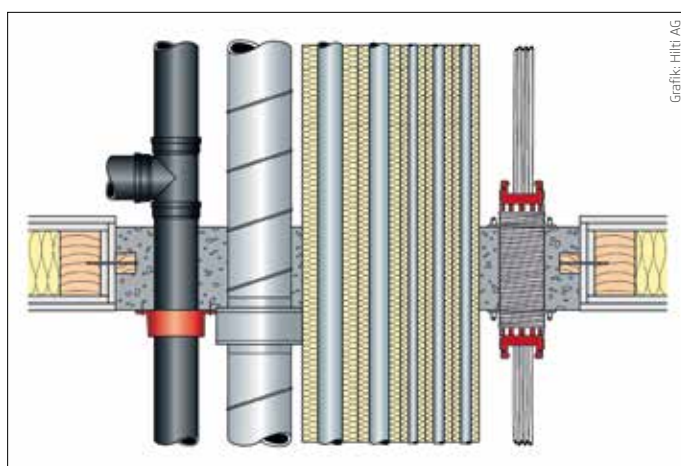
Verschluss mit mineralischen Baustoffen in einer Holzbalkendecke
